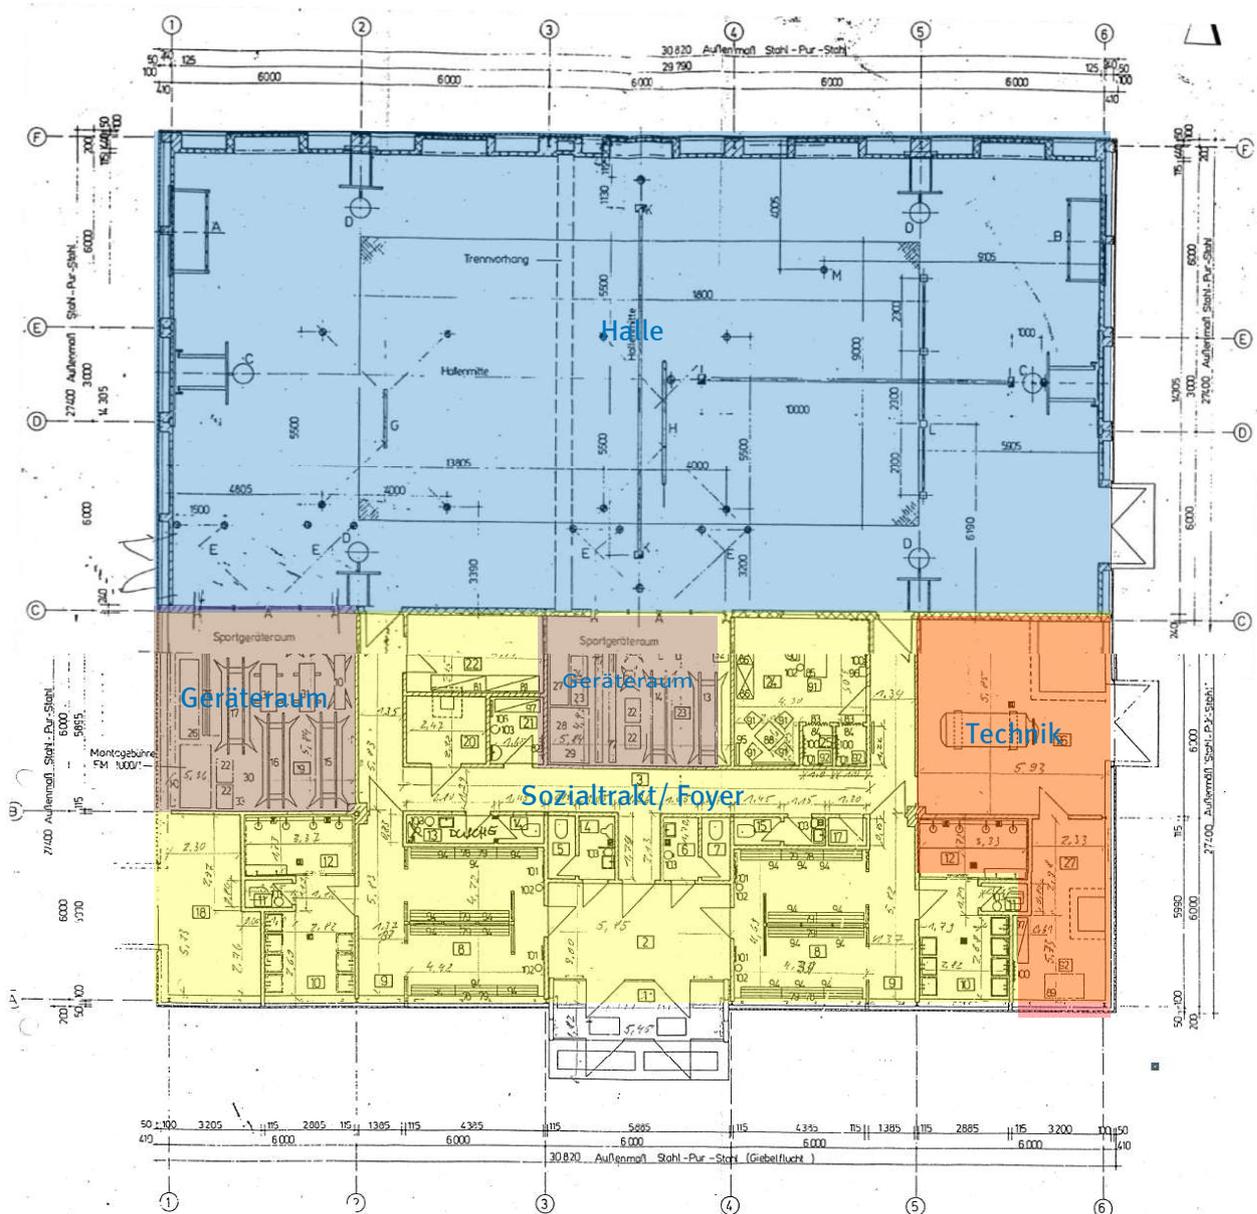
Grundriss TH 27 - Typ SH 15 x 30 LM (Quelle: ZGM)
